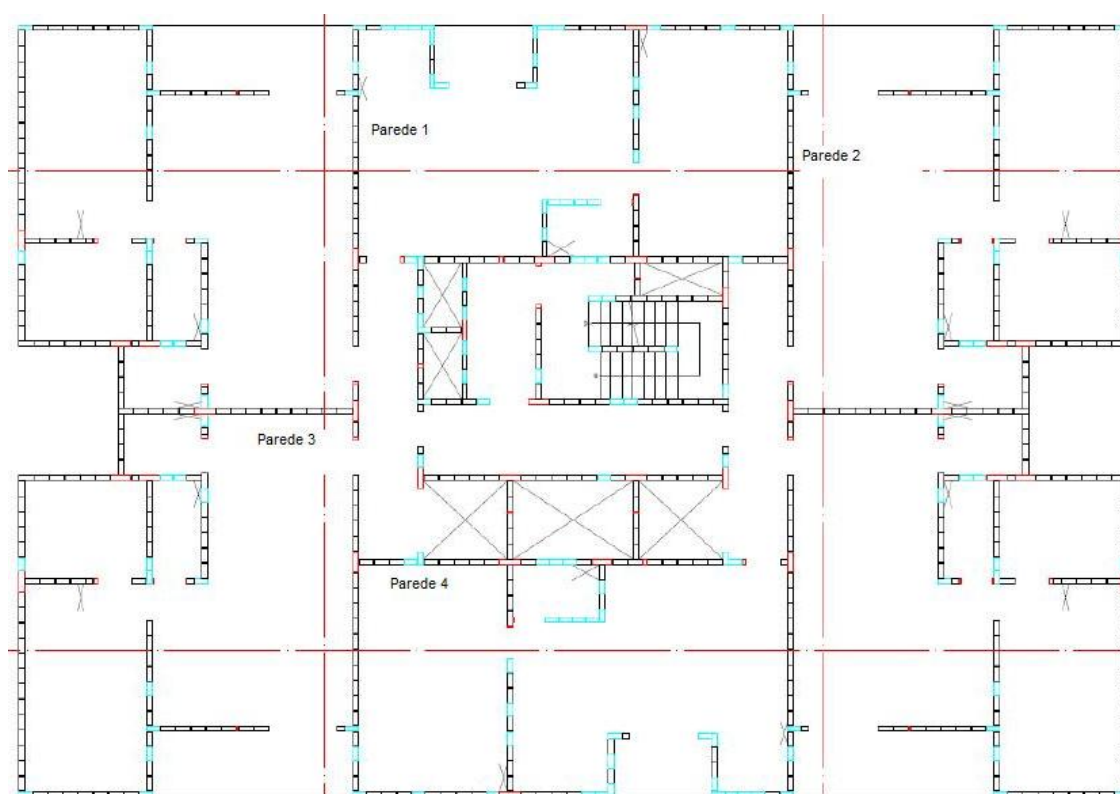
Planta Baixa com alinhamento de paredes. (Puga,2008).
